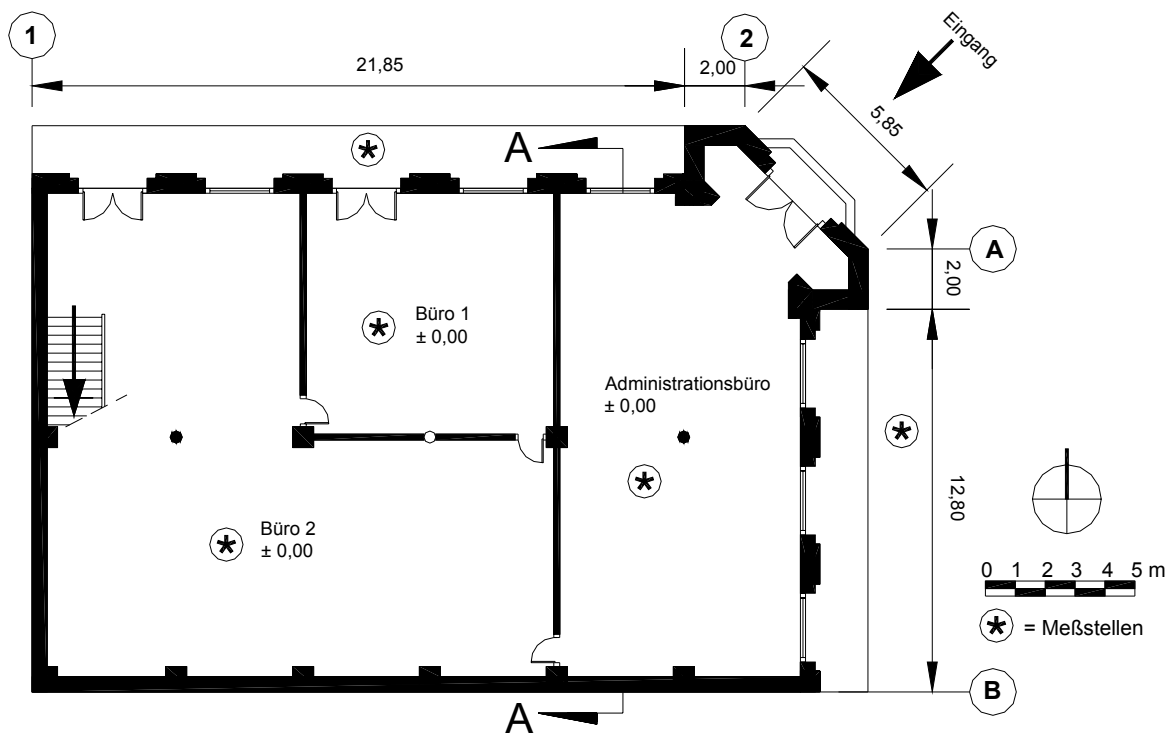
Grundriss Erdgeschoss von Gebäude A2
